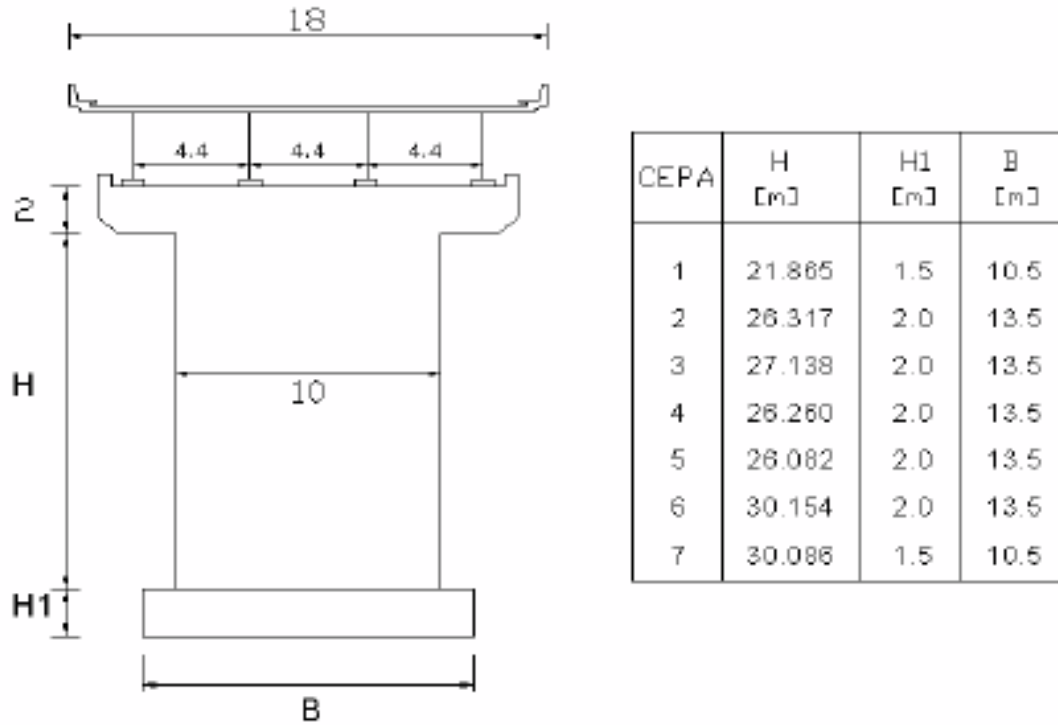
Descripción de las pilas en el puente (Taylor 2007)
